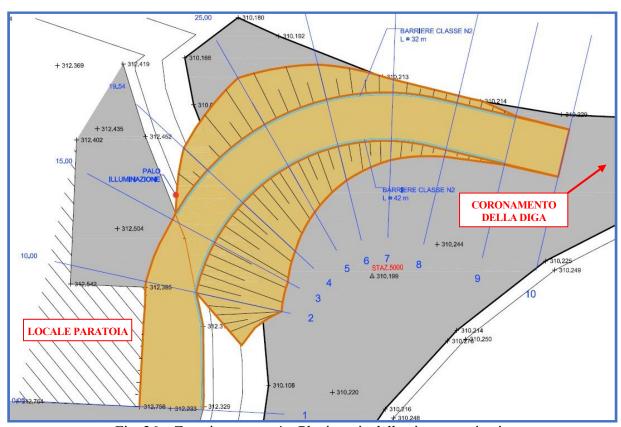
Zona intervento 4 – Planimetria della pista provvisoria
